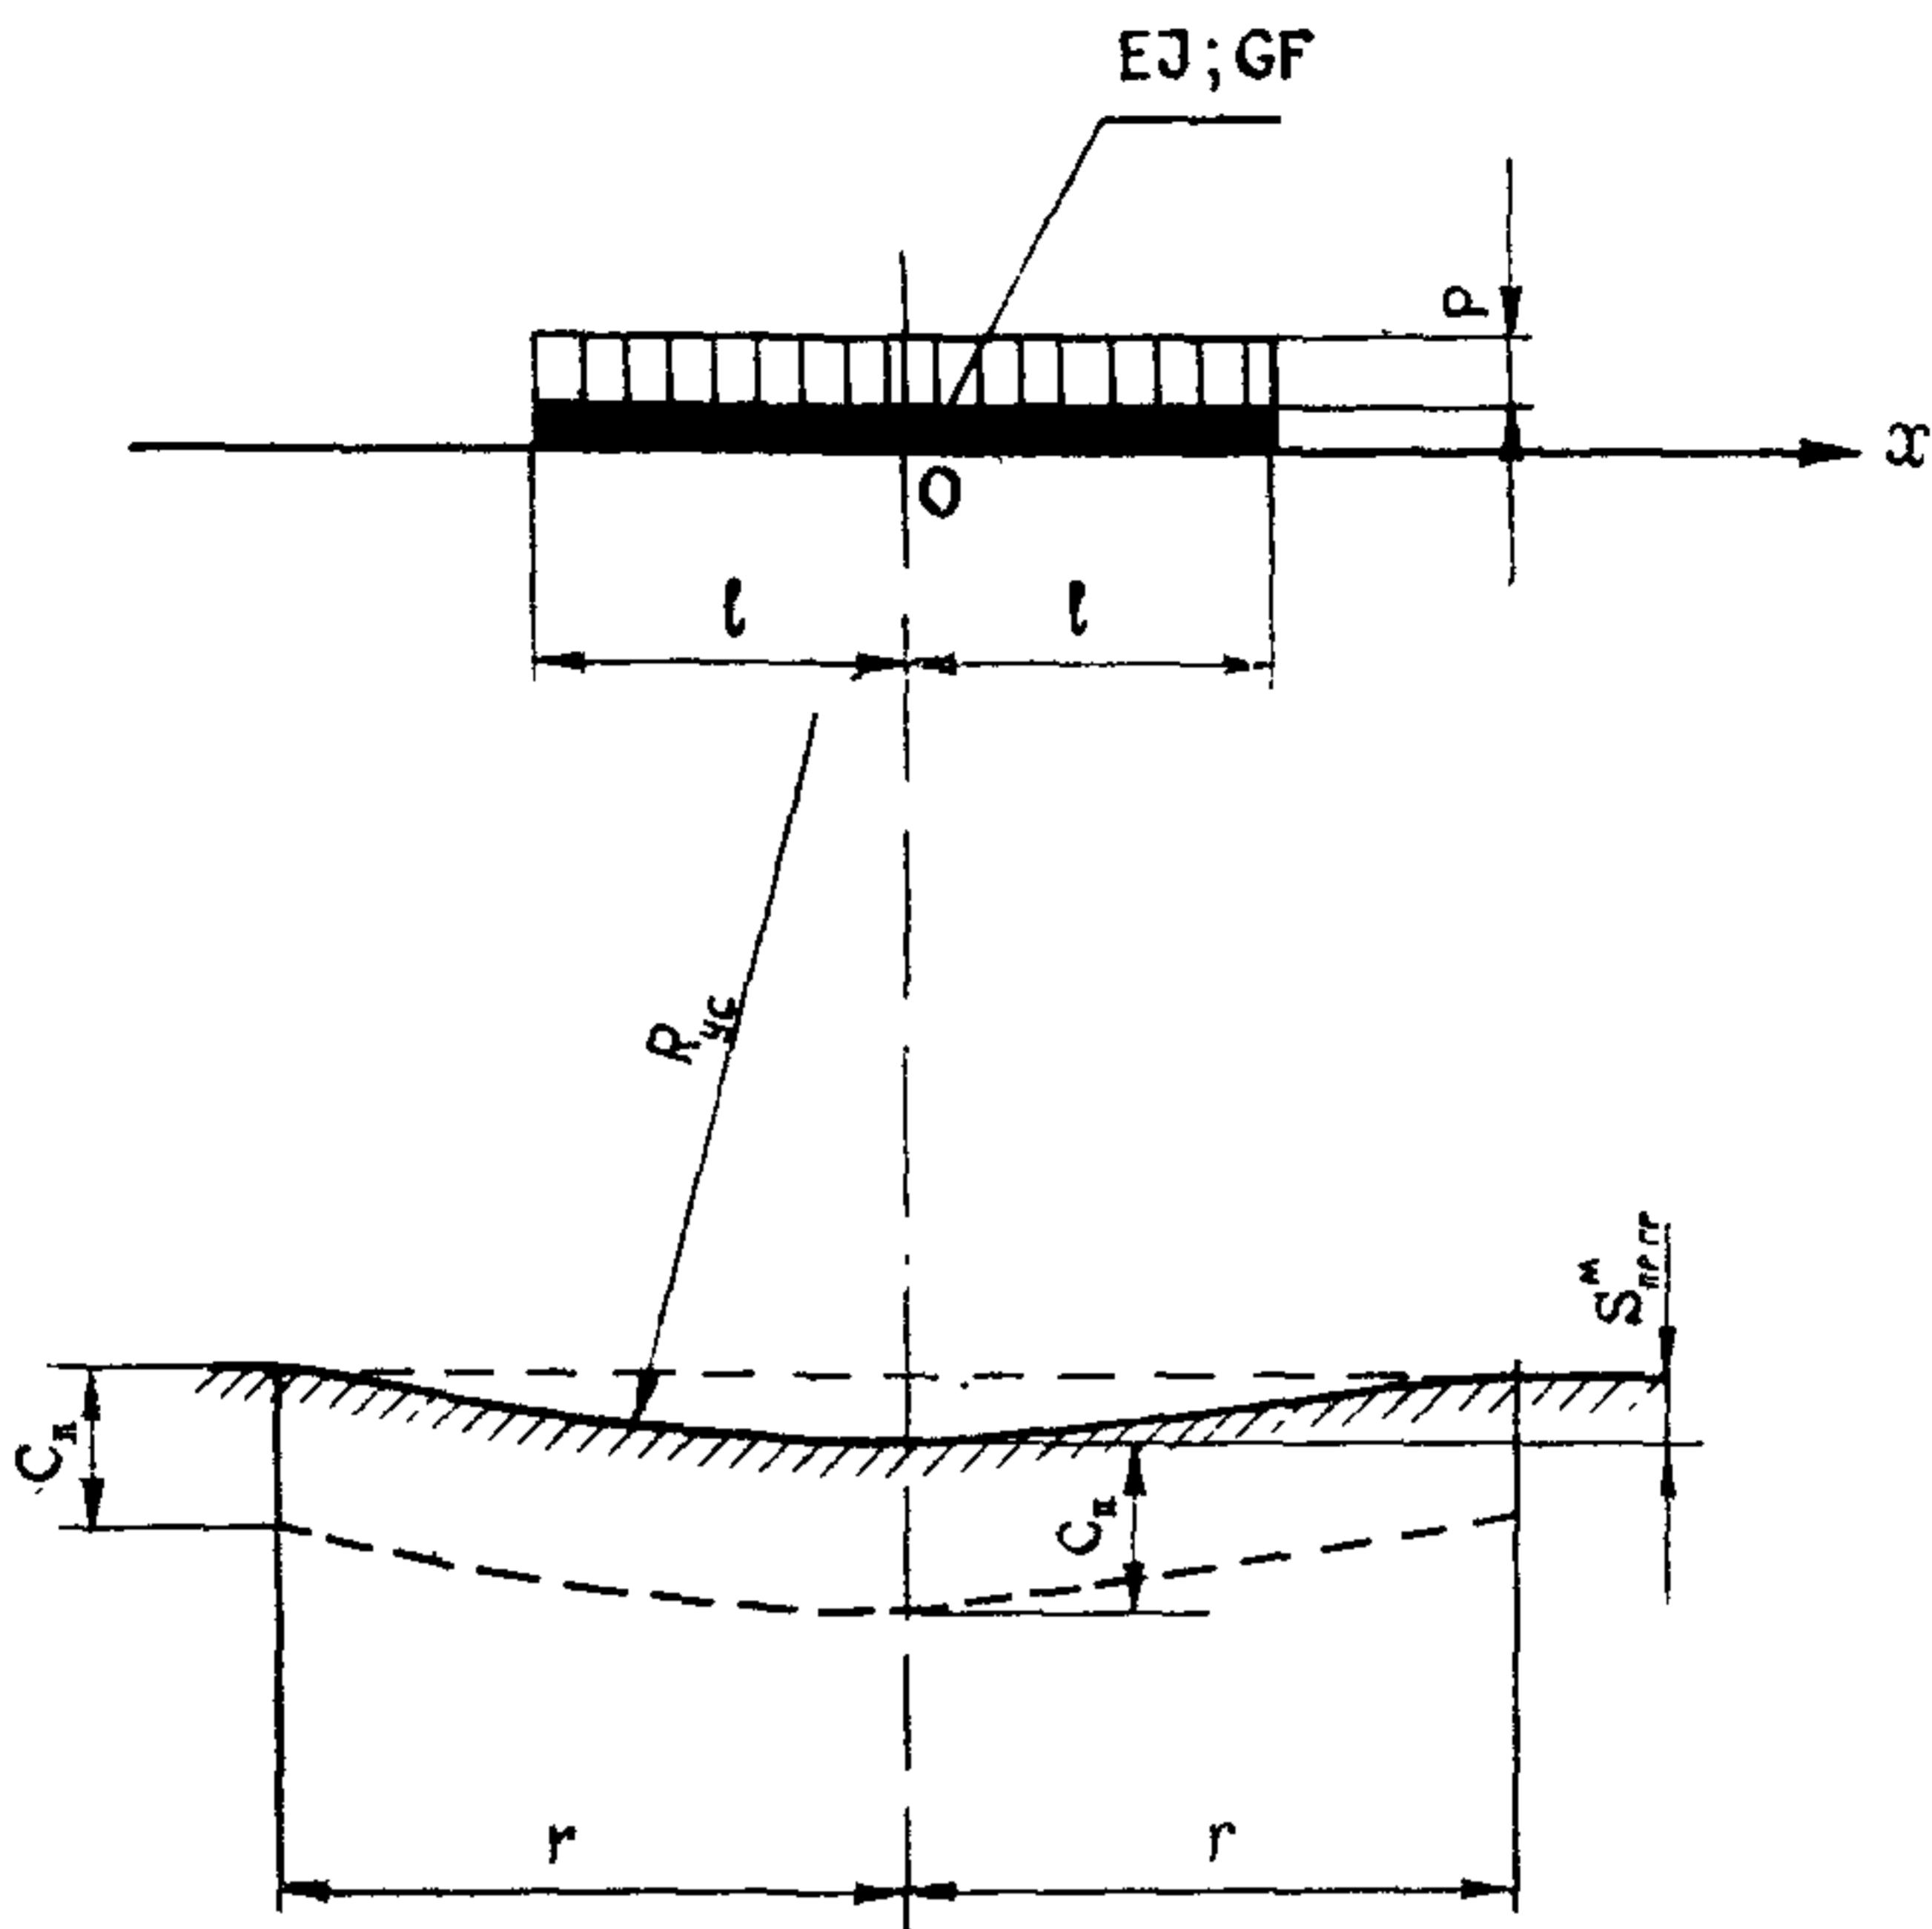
Схема и основные расчетные параметры искривленного основания при расчете зданий на просадку грунтов от собственной массы.
